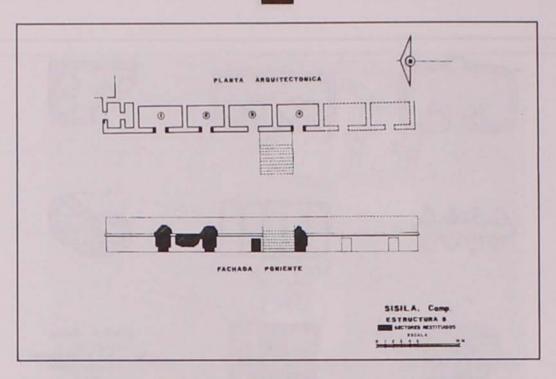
Planta y alzado del Edificio 5 de Sisilá.
